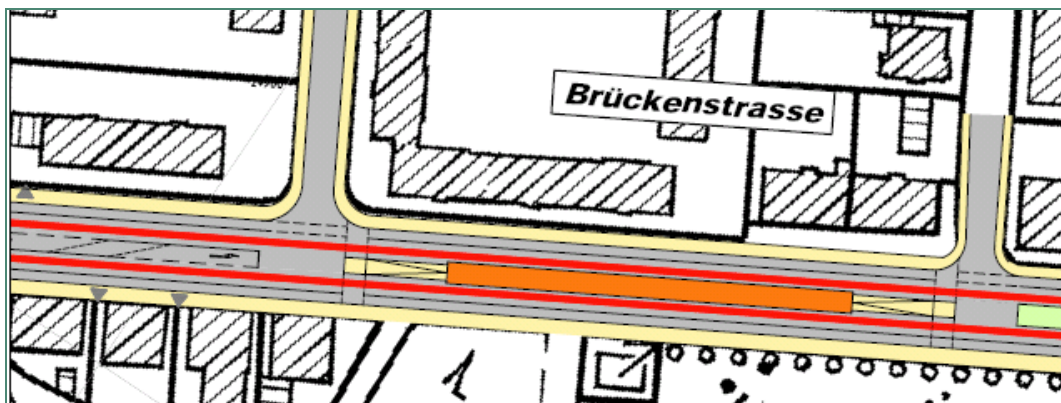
Heeper Straße im Bereich Brückenstraße
